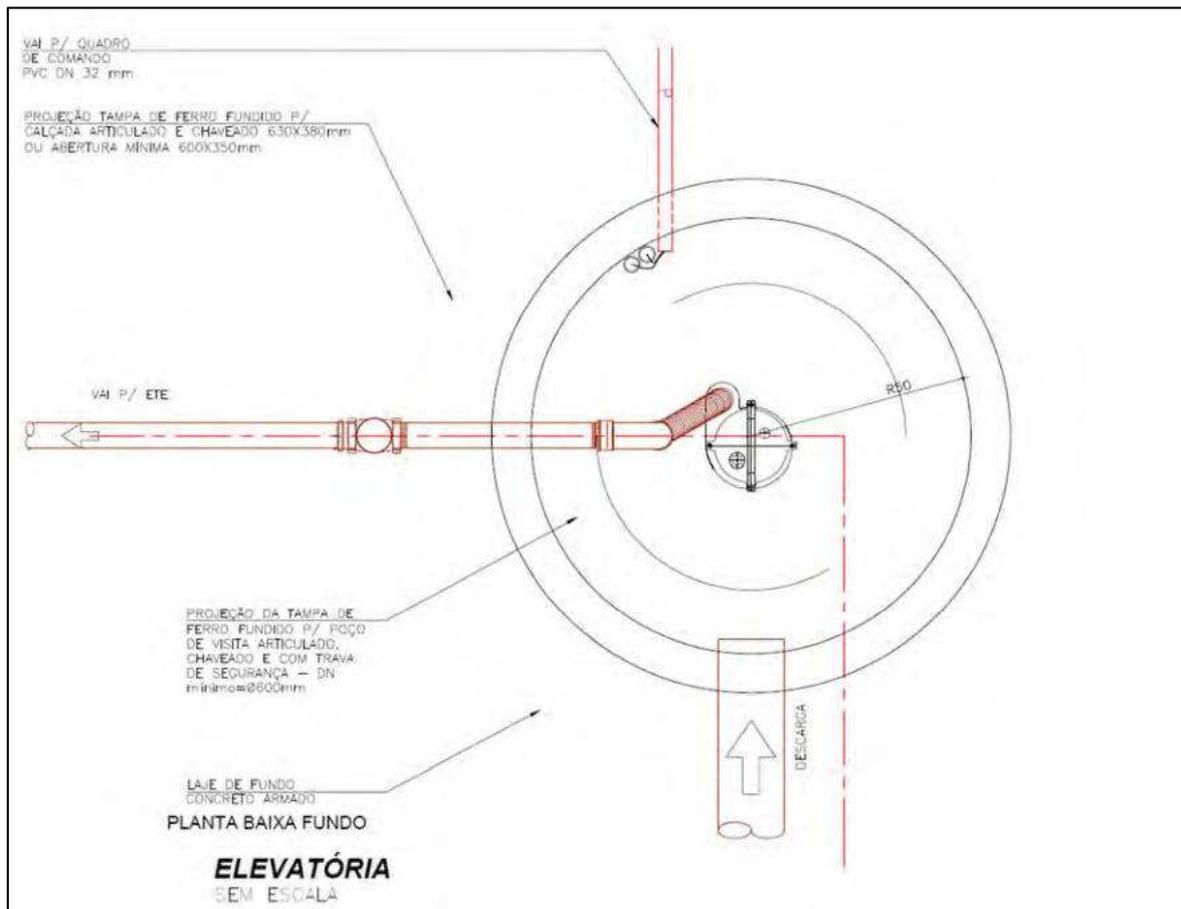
Planta baixa da estação elevatória do sistema de tratamento de efluentes do Centro Náutico Porto do Sol.
